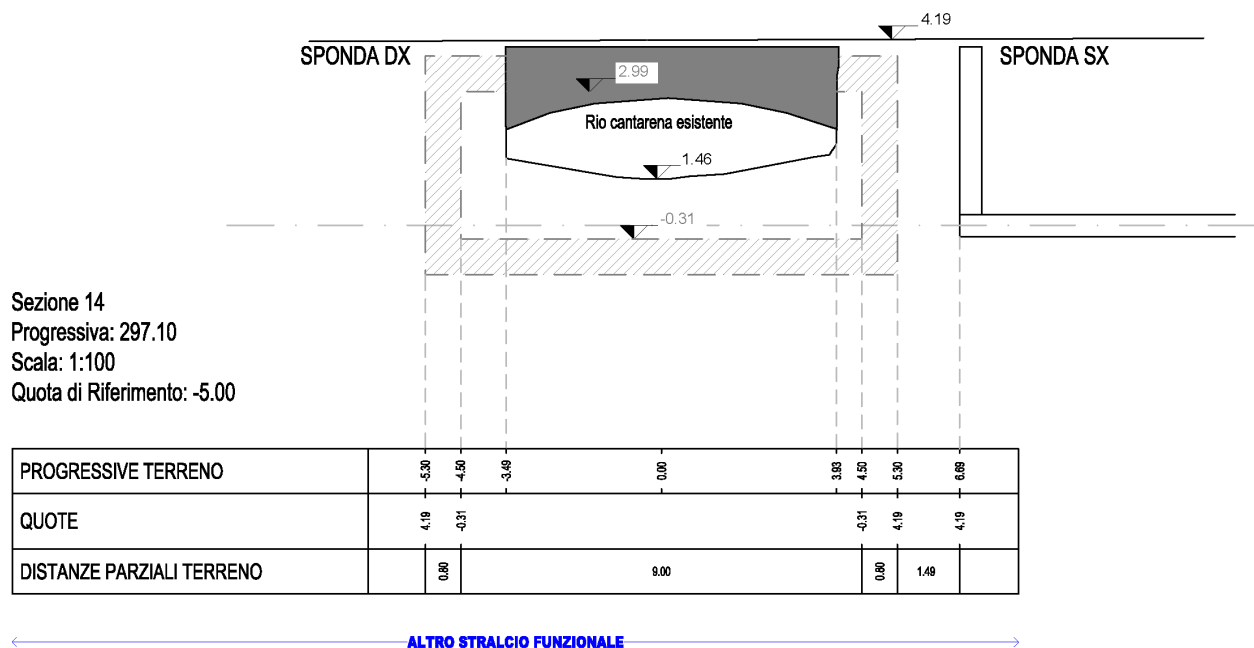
Sezione 14 della situazione attuale (grigio) e di progetto (rosso) del rio Cantarena.
